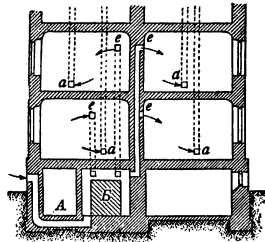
Схема воздушного отопления при использовании внешнего воздуха: А—воздухопроводный канал, Б—калорифер, ее—жаровые каналы, аа—вытяжные каналы.
